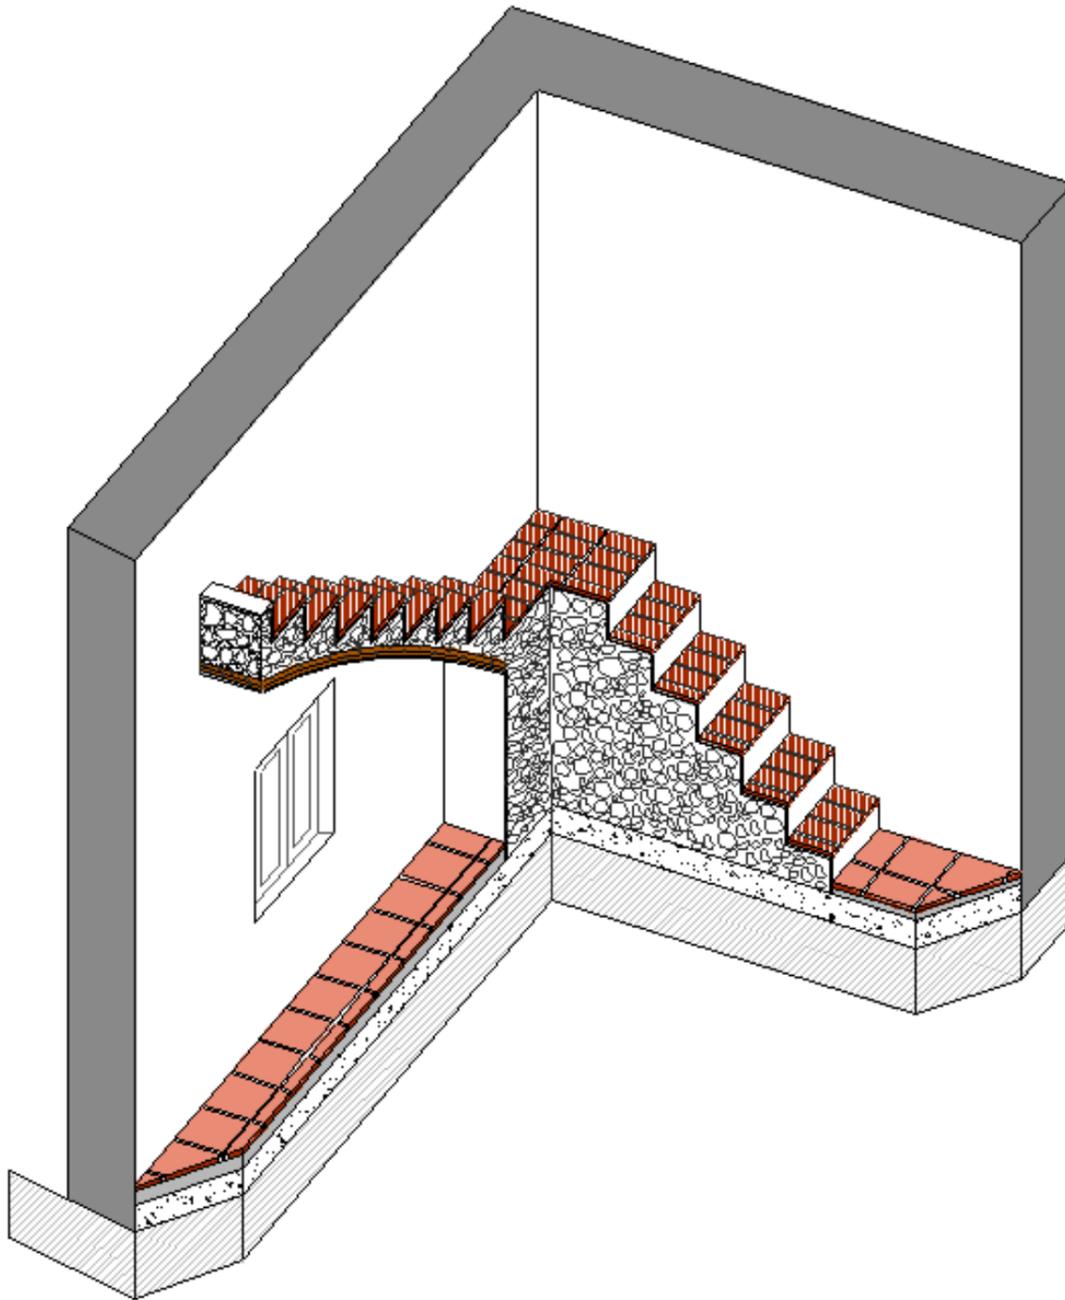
Hipótesis de sección escalera acceso planta 1. Fuente: autor propio
